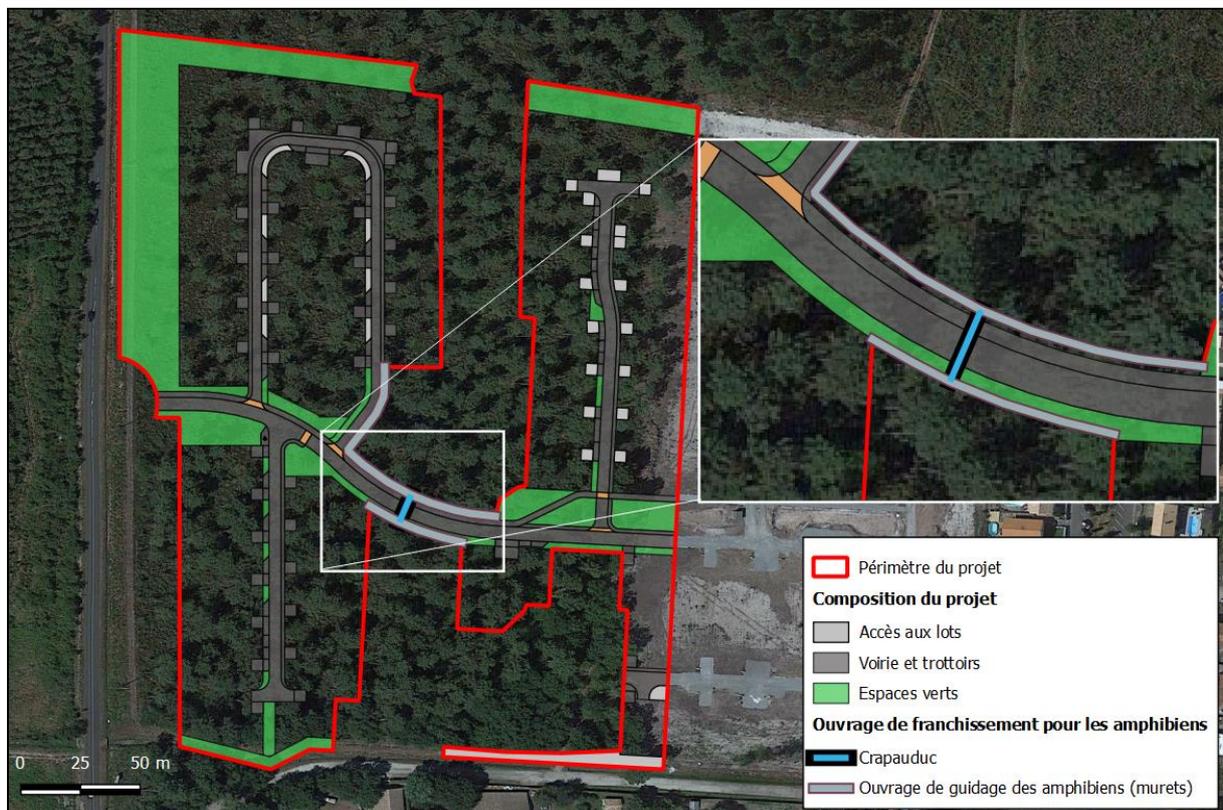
Détails de l'installation de l'ouvrage de franchissement
